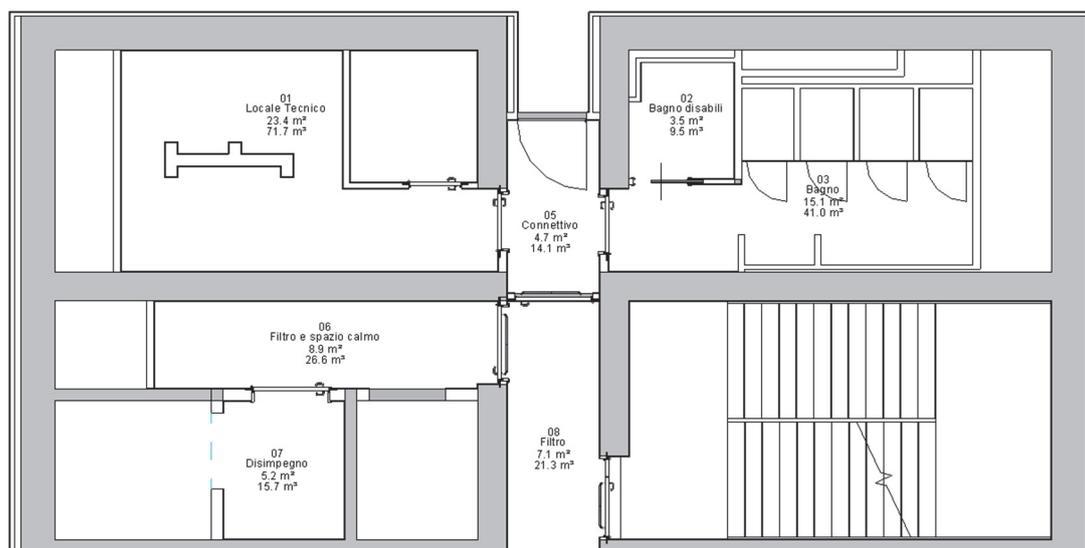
Stralcio pianta livello 10 con etichette locali
